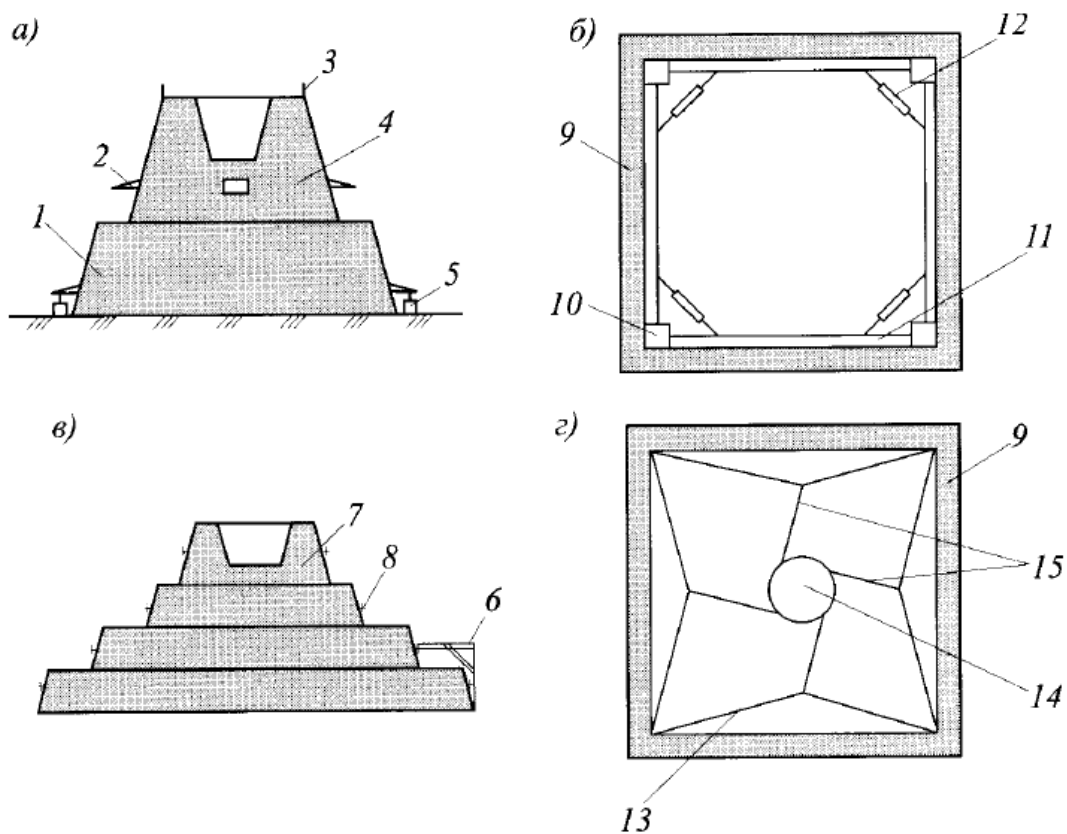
Блочные опалубки и блок-формы для фундамента: *а* – неразъемные блок-формы фундамента; *б* – разъемная блок-форма; *в* – крупноблочная опалубка со стяжными муфтами; *г* – крупноблочная опалубка с гибкими щитами. 1 – нижний блок фундамента; 2 – кронштейн для упора домкрата; 3 – монтажная петля; 4 – верхний блок ступени фундамента; 5 – домкрат; 6 – отрывное устройство; 7 – блок форма стороны фундамента; 8 – замковое соединение; 9 – бетонизируемая конструкция; 10 – опалубочный каркас; 11 – Палуба; 12 – стяжка; 13 – гибкий щит опалубки; 14 – поворотная стойка; 15 – щитовые тяги
